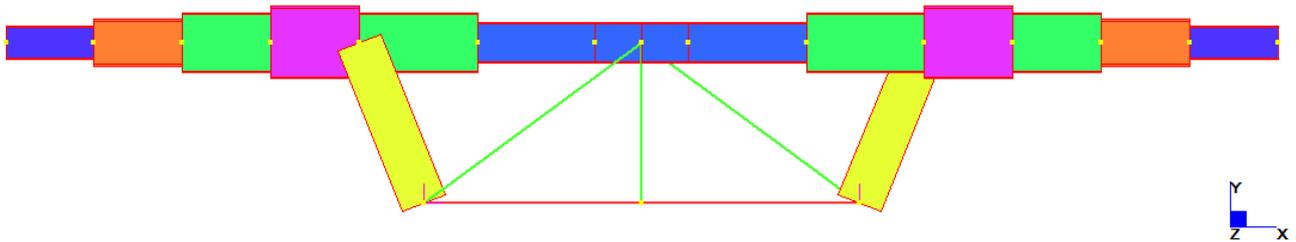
Modello FEM Traverso di campata – Elementi beam
